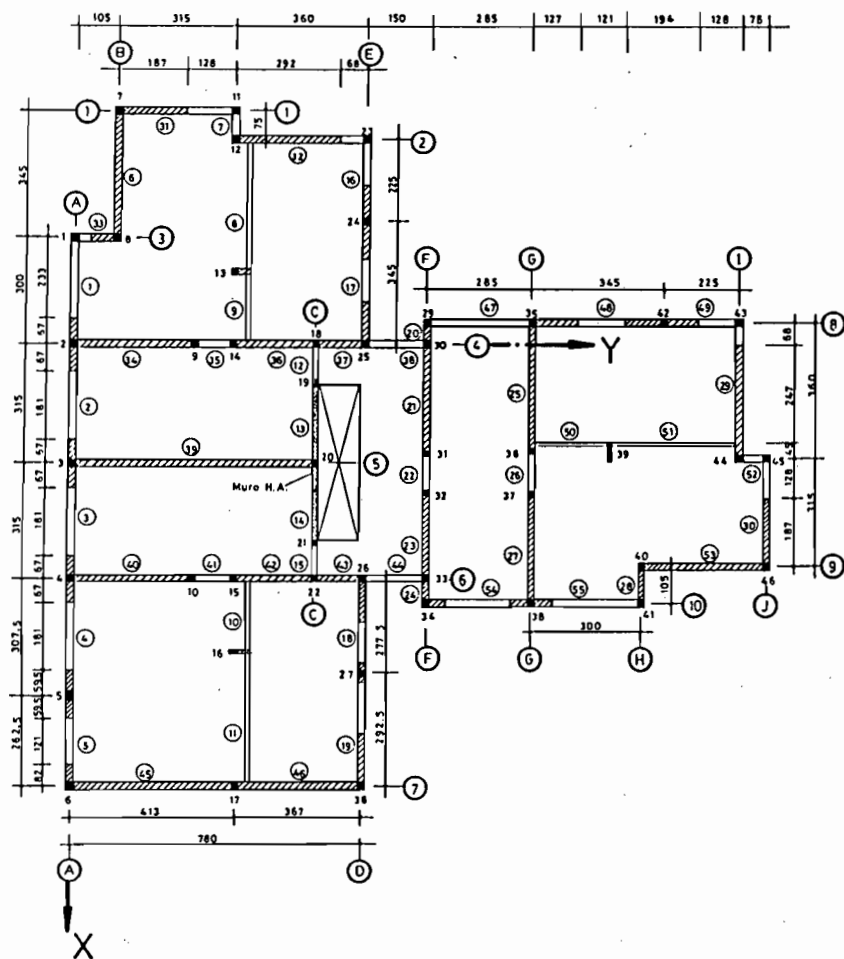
Planta típica edificio Emilia Téllez (albañilería de ladrillos cerámicos).
